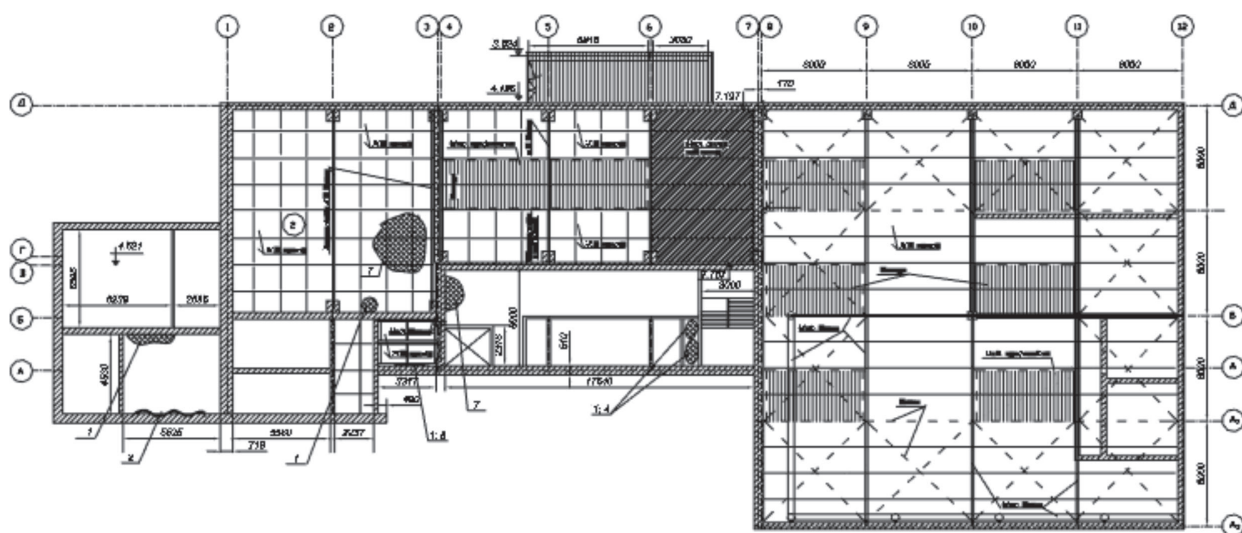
Схематический план покрытия первого этажа зданий «Хрустального участка»
